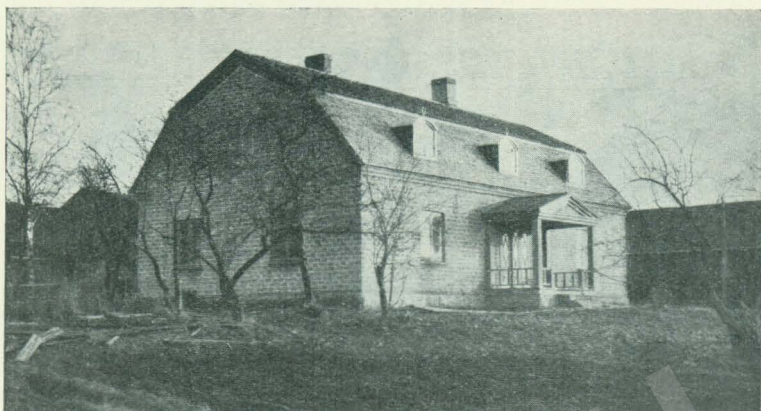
Murowanie ścian z cegły cementowej z pustymi przestrzeniami. Fundament przy tym budynku zrobiony jest z sypanego betonu.
